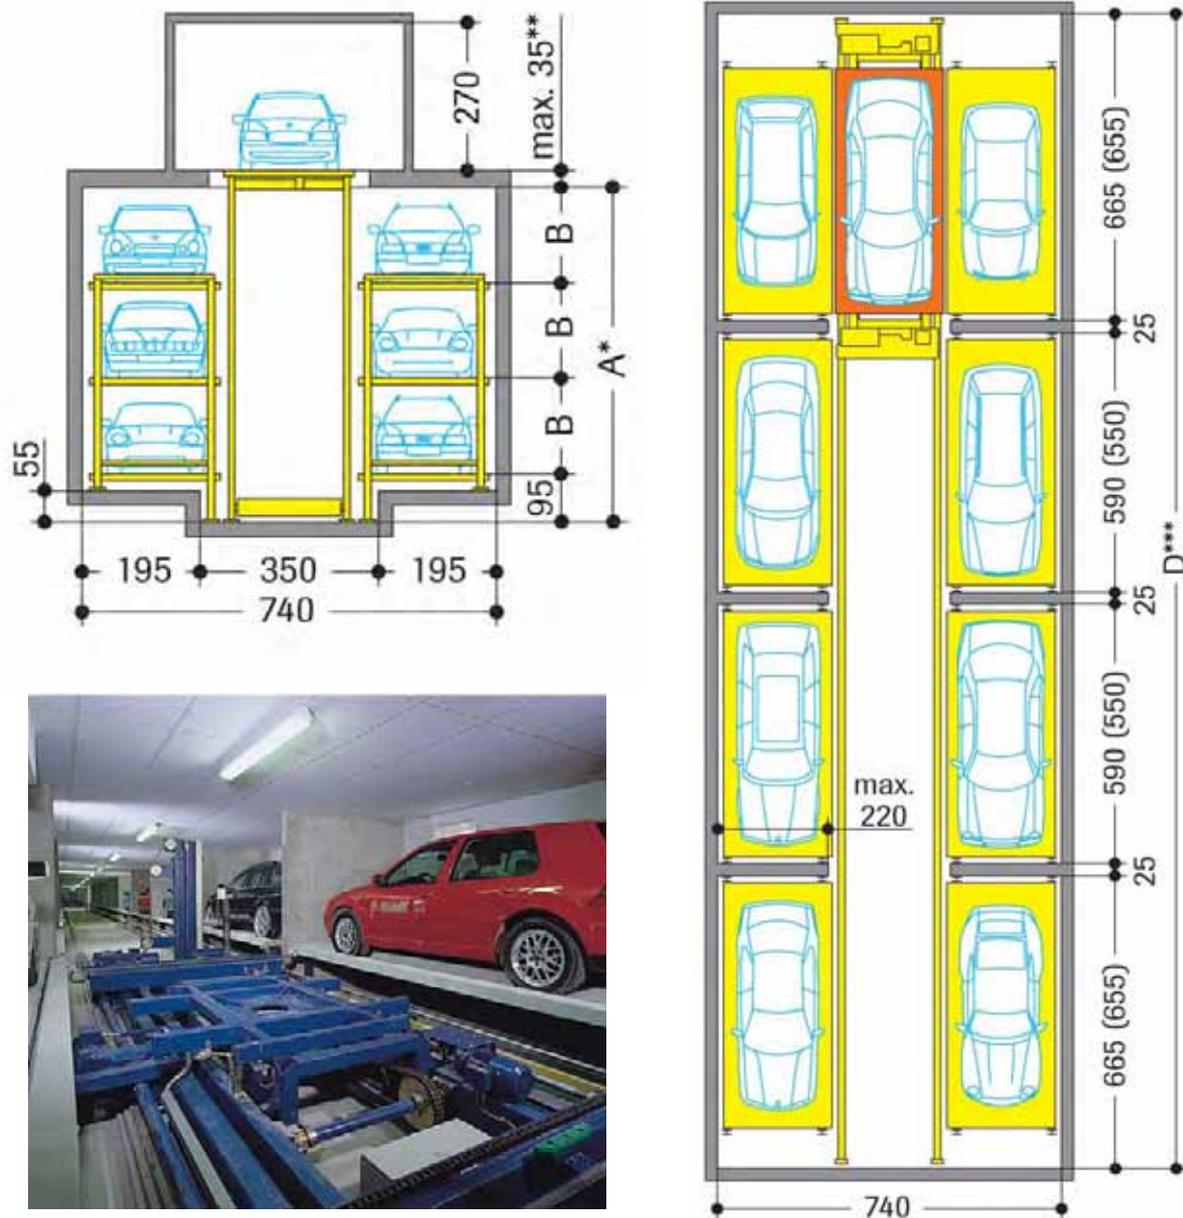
Sección, planta y vista de un sistema *Multiparker* con disposición longitudinal de aparcamiento.
